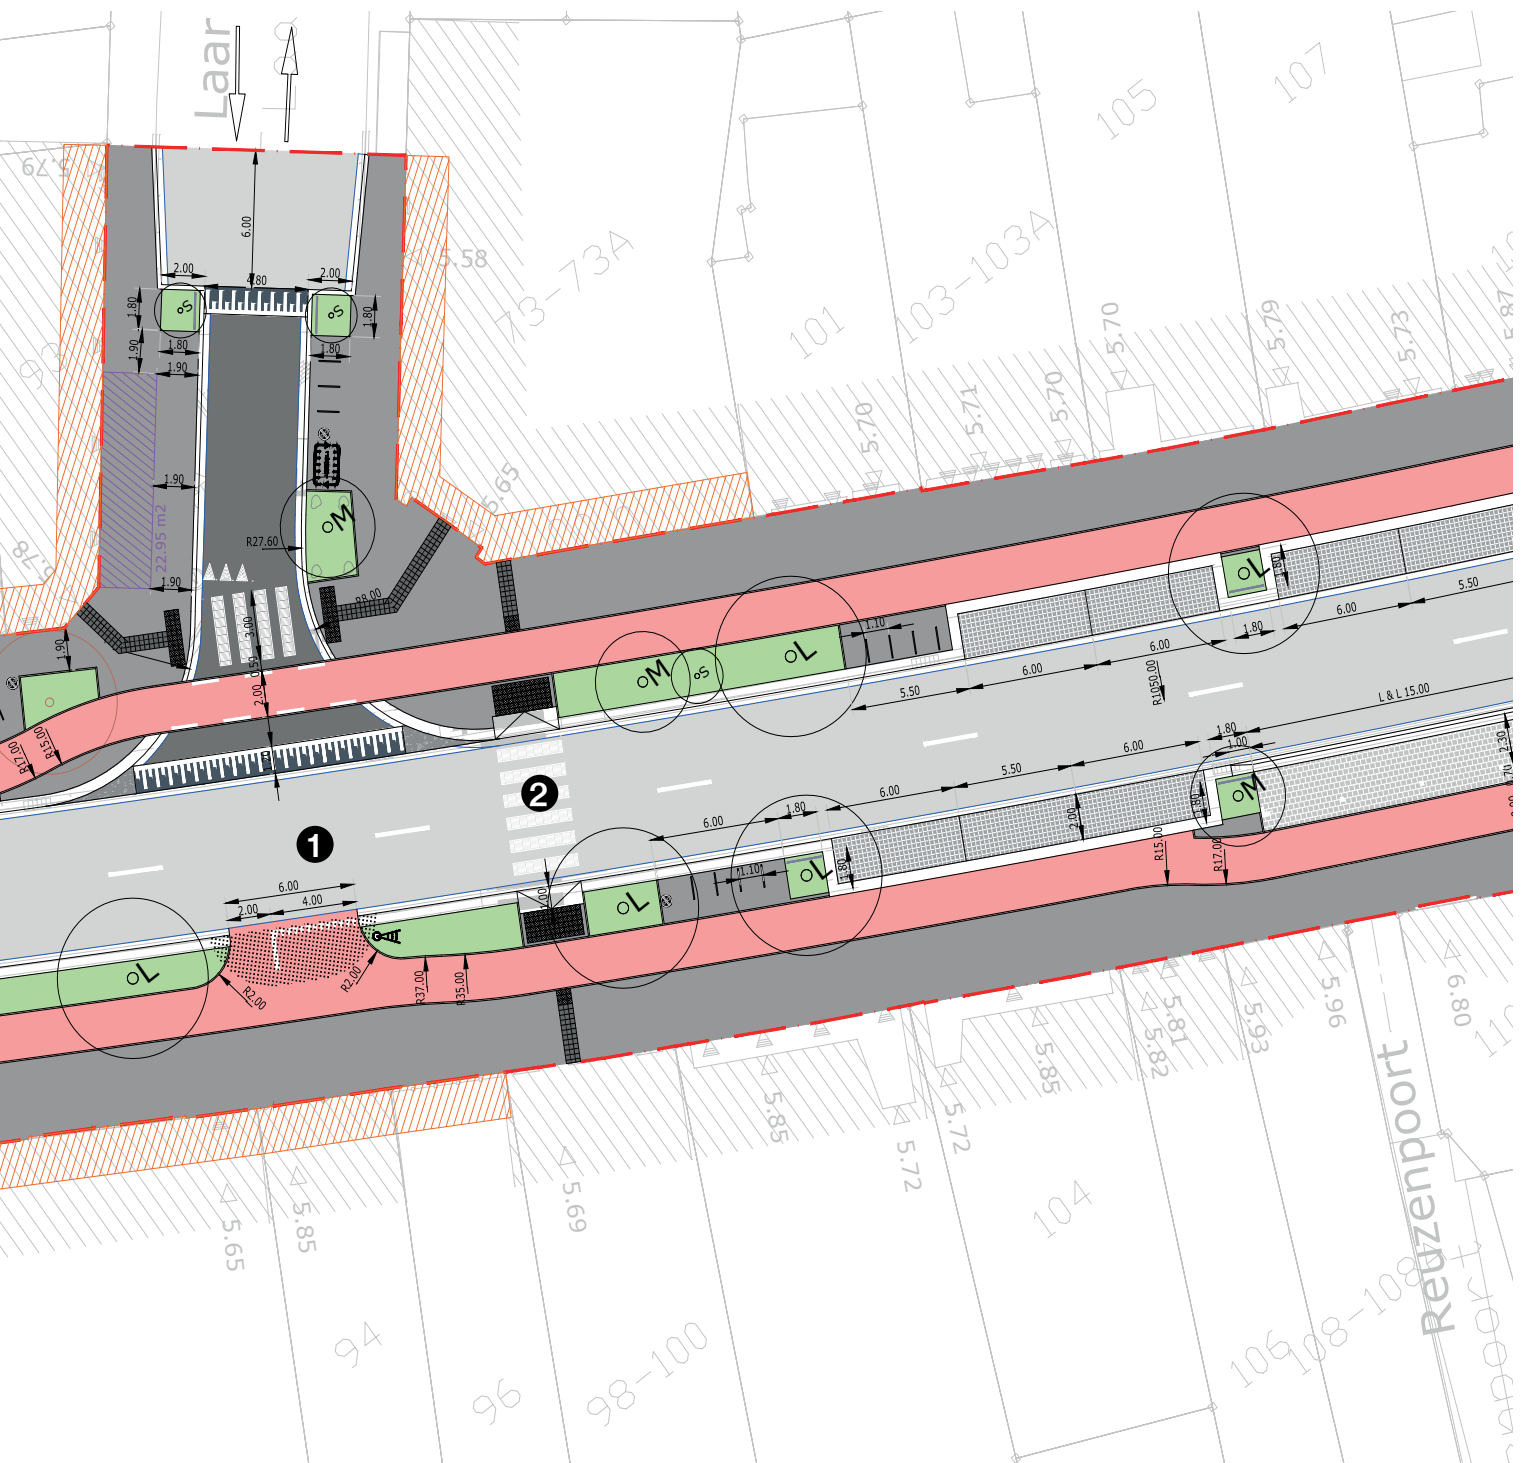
Mogelijke oversteekvoorzieningen bij 30 km/u (Bron: Vademecum Afwegingskader Oversteekvoorzieningen).
